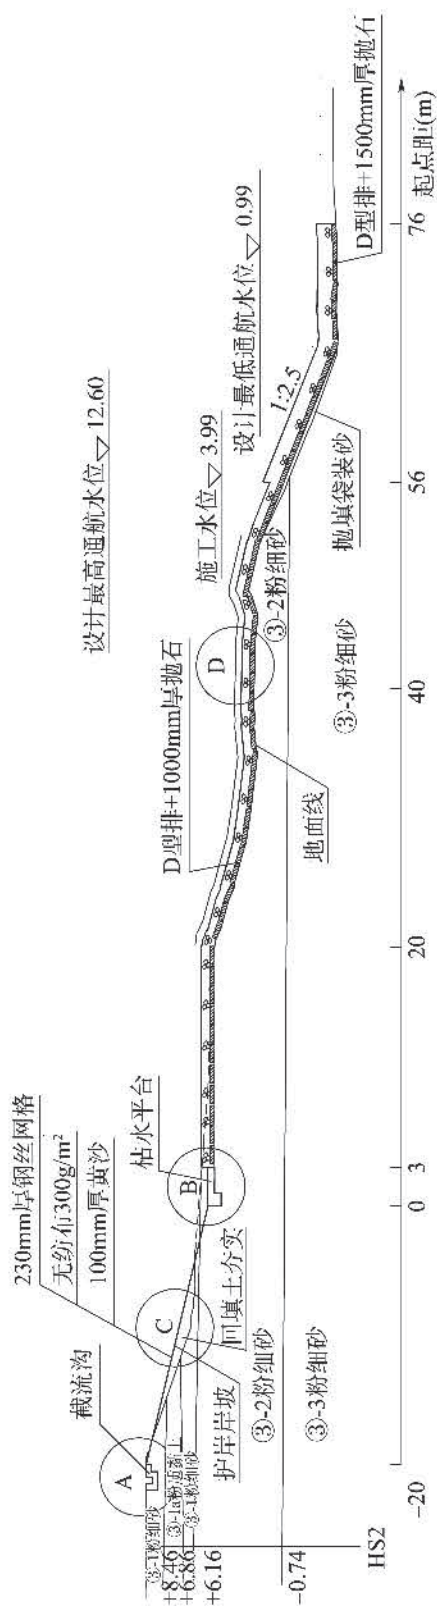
航道整治工程-长江下游某航道整治工程-新建护岸断面示意图(尺寸单位:mm;高程单位:m)
